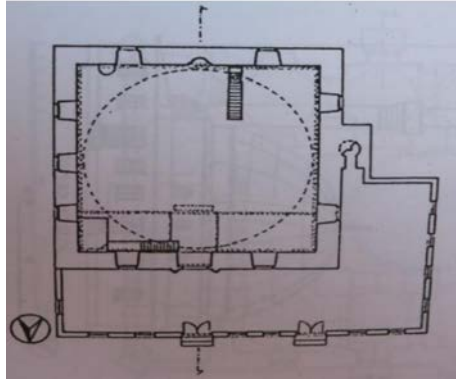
Sandıklı Cami yapılması planlan cami ve şadırvan planı
